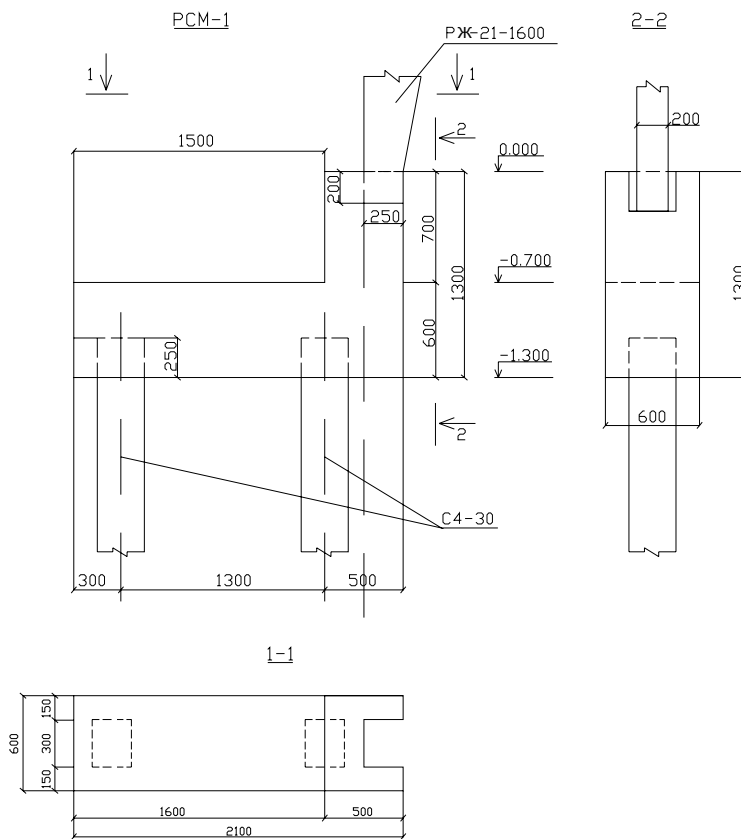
Конструкція палевого фундаменту із монолітним ростверком з консоллю в будинку плавального басейну
